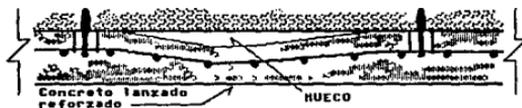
SECCION EN PELIGRO DE DESPRENDIMIENTO
